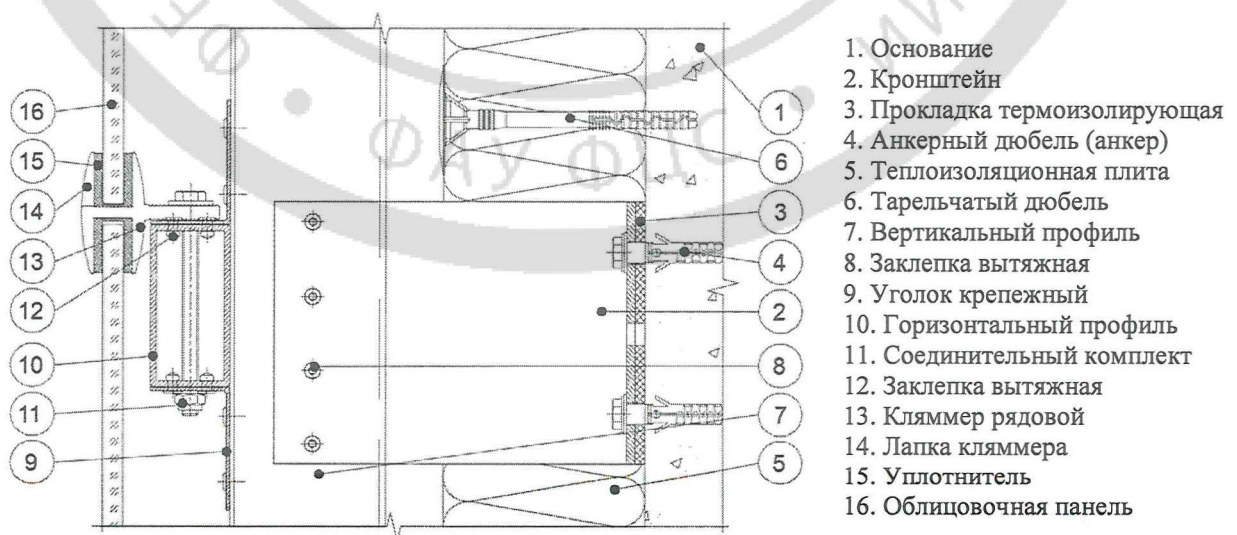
Вертикальный разрез фасадной системы «MLK-v-300» (первый вариант конструктивного исполнения несущего каркаса)
